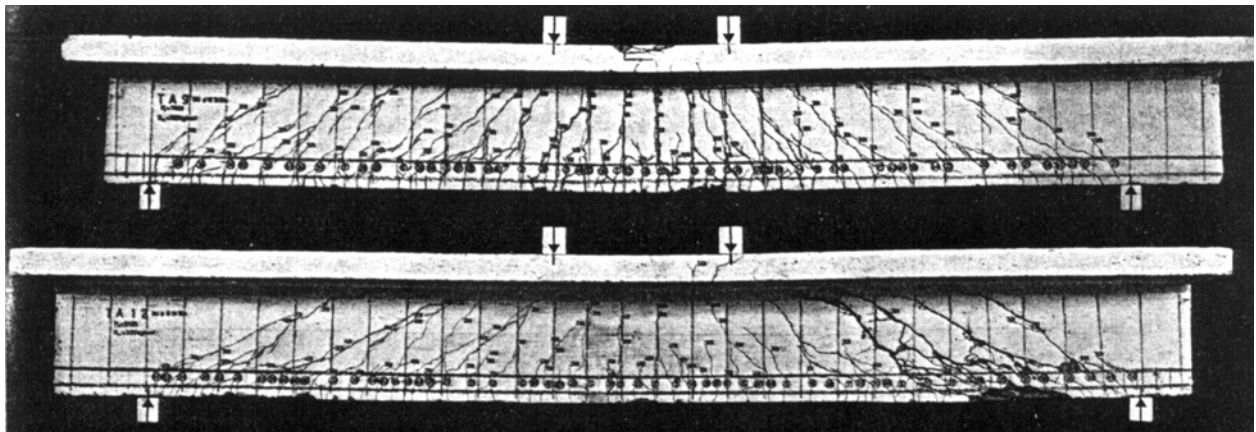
Rissbild im Bruchzustand querkraftbewehrter Balken nach den Stuttgarter Versuchen [leon_1]
